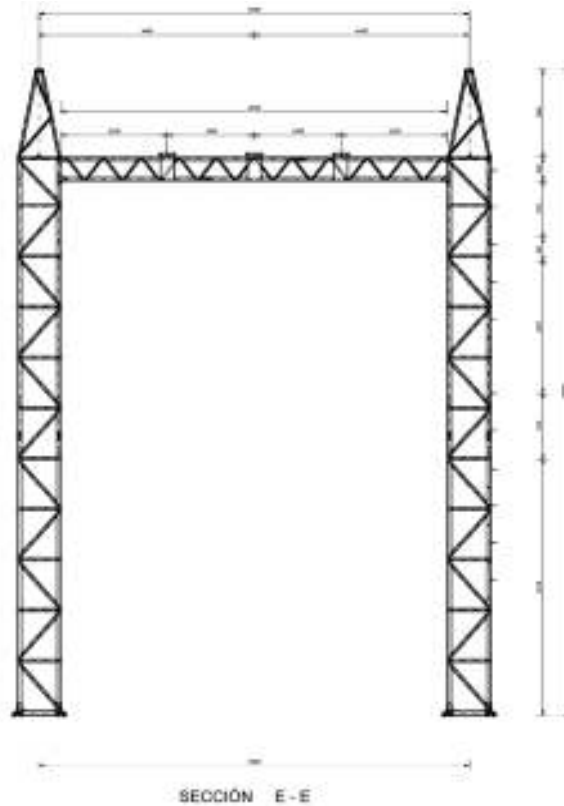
Sección E - E de la estructura metálica de la barra de 69 kV.
